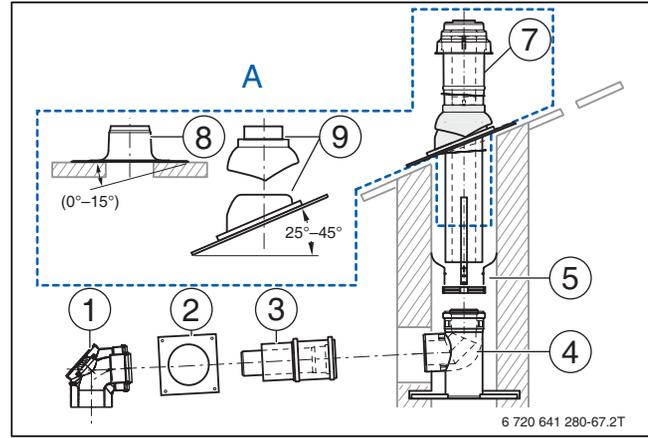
Bauteile Grundbausatz DO-S aus Kunststoff
